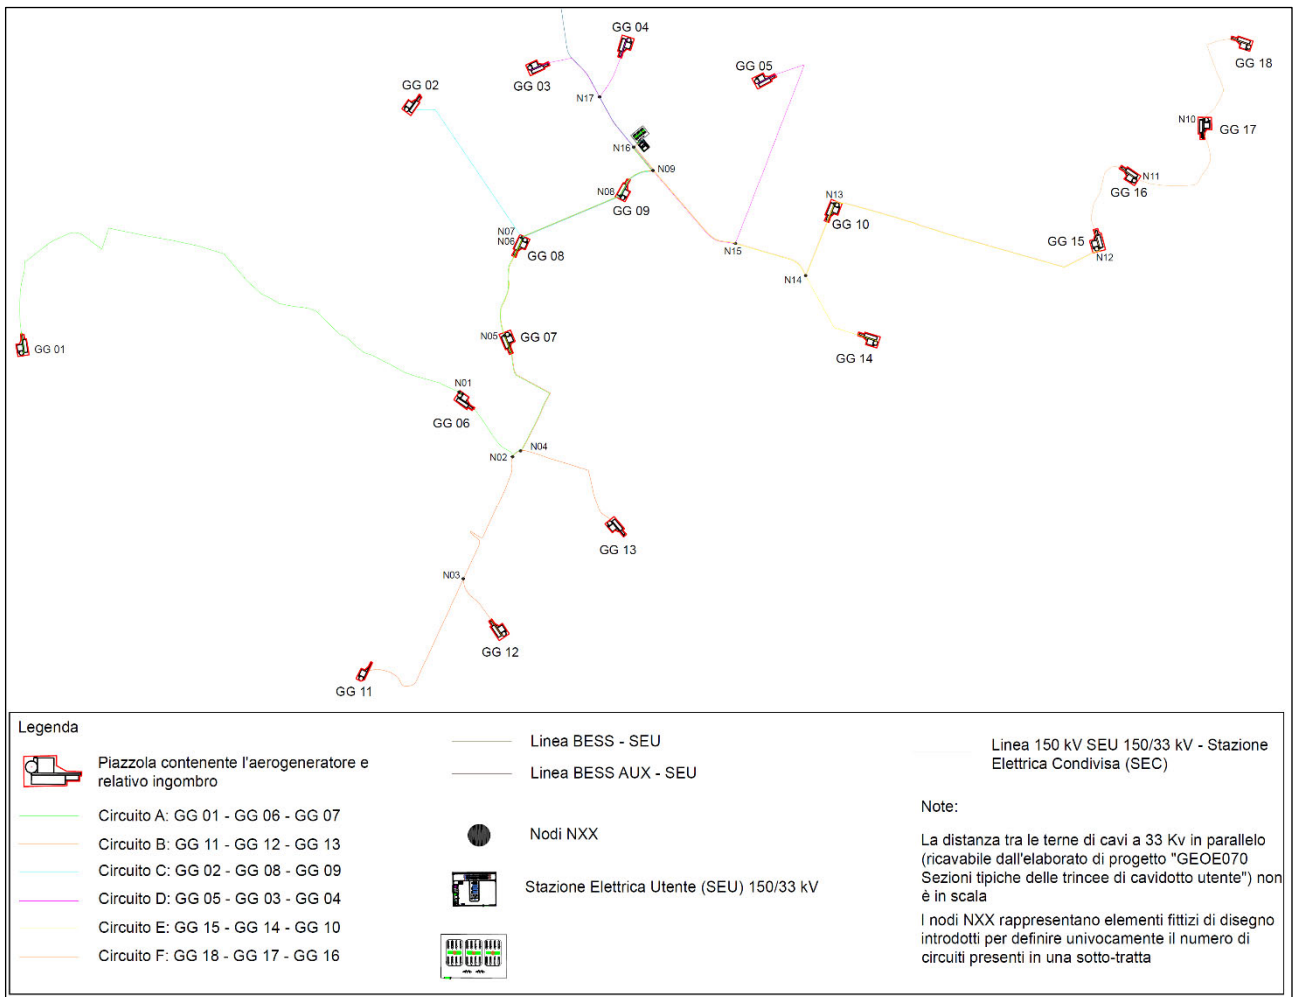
Dettaglio 1 - planimetria di distribuzione linee di collegamento a 33 kV
